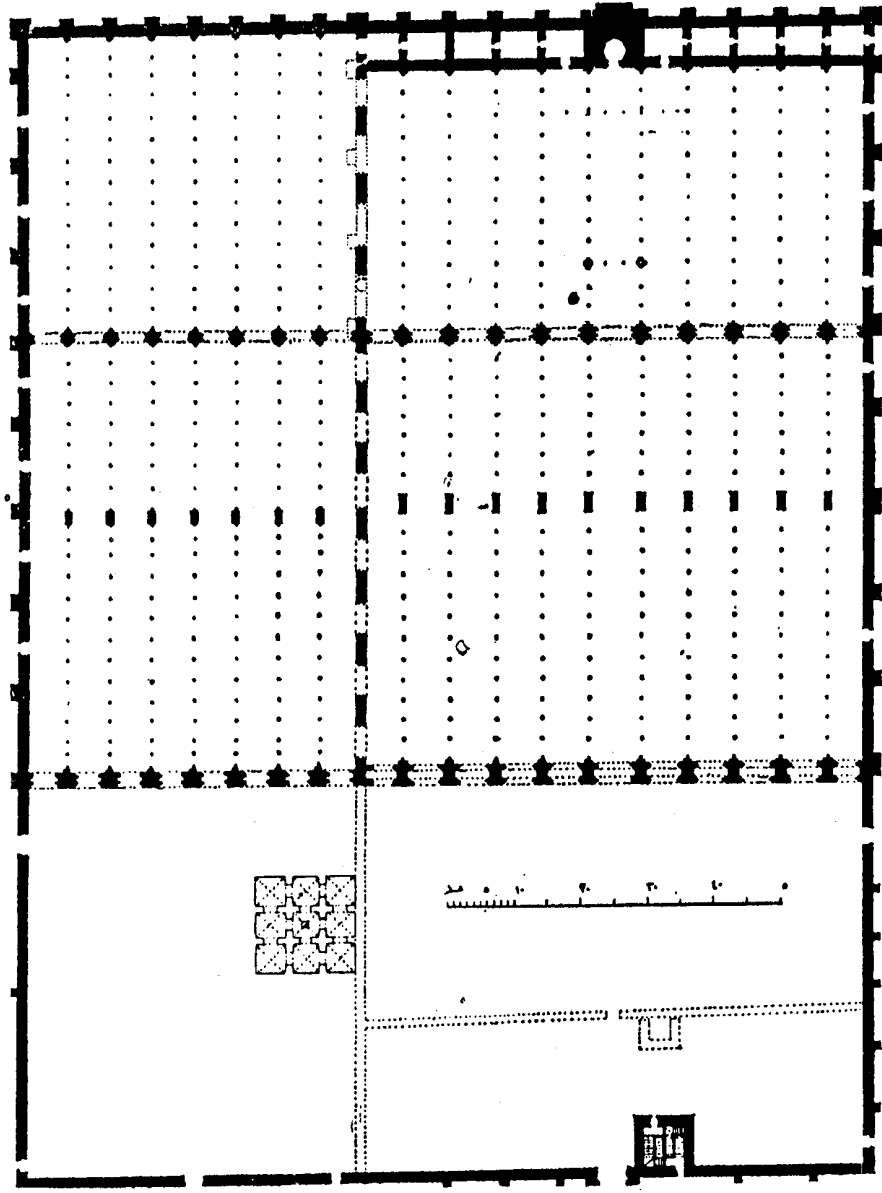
مسقط أفقي للجامع الاقصي في عهد الخليفة العباسي المهدي (عن : Creswell)
